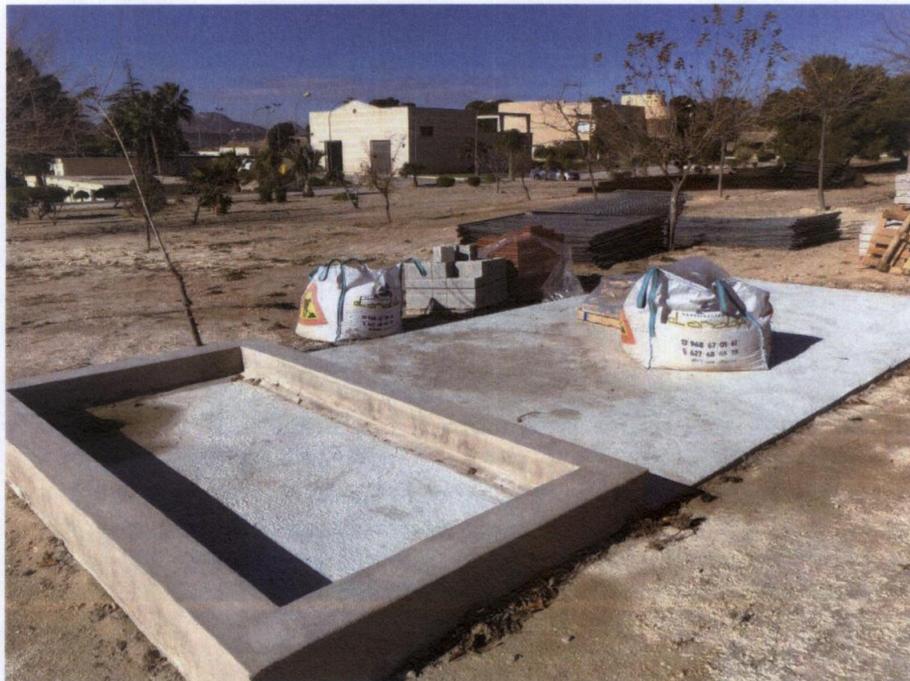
Vista del recinto para lavado de cubas de hormigón impermeabilizado, delimitado e identificado
